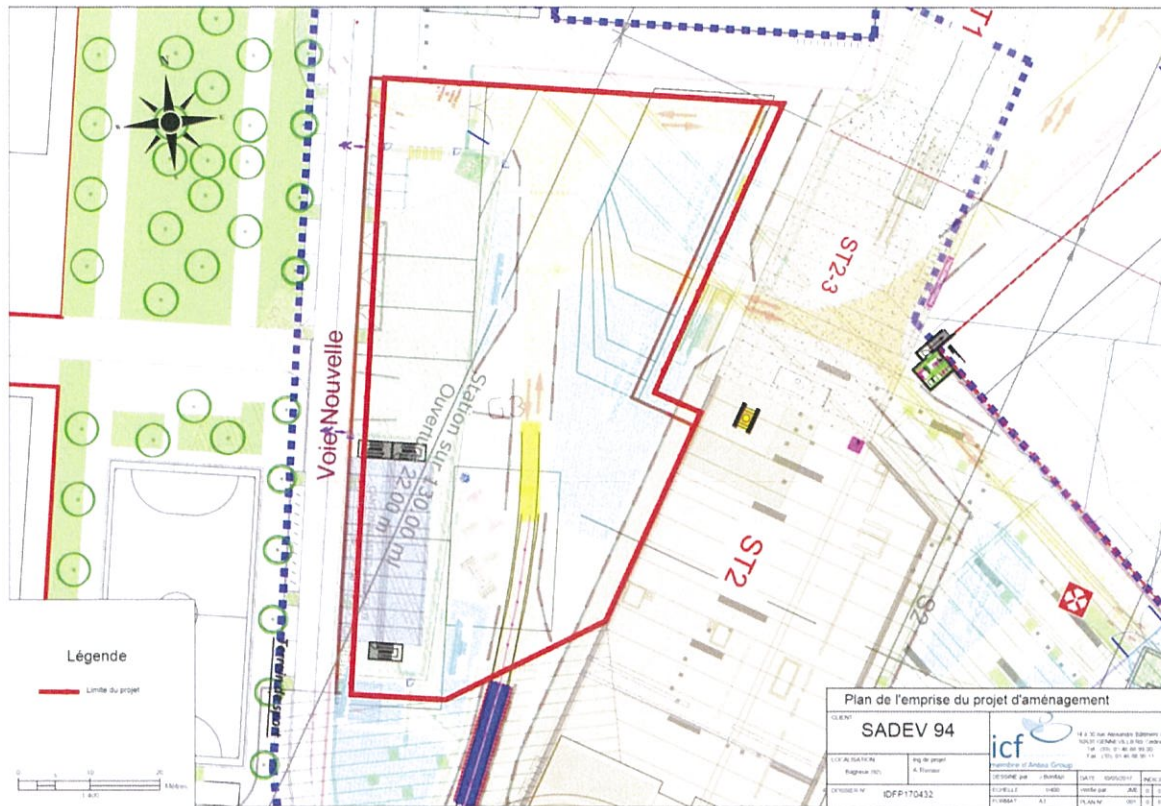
Plan de l'emprise du projet sur l'emprise chantier RATP
